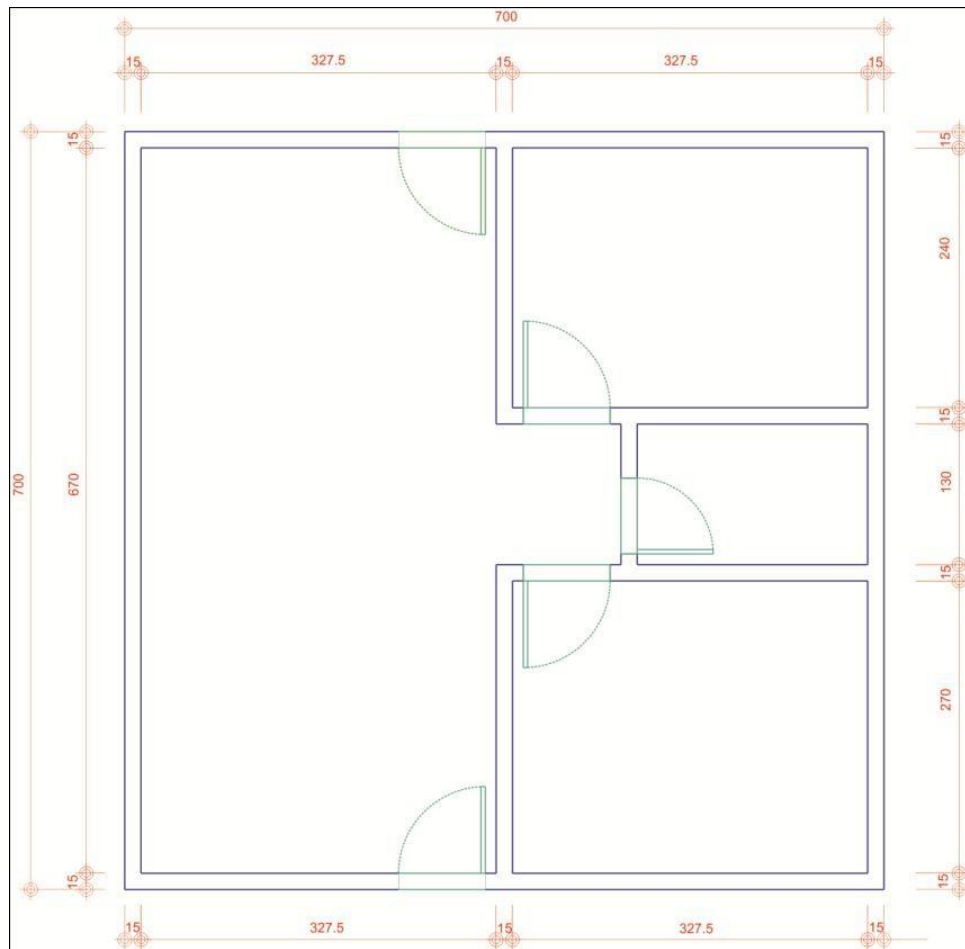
Planta baixa casa em estudo. Fonte: Autor, 2019.
